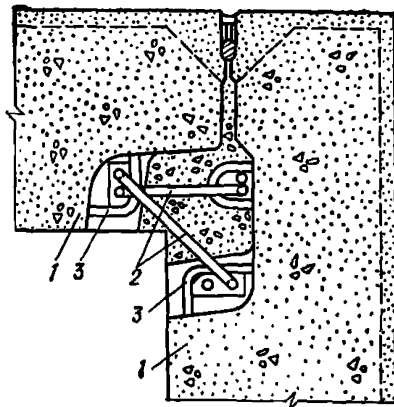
Сопряжение наружных стеновых панелей в углу здания под перекрытием (в уровне поэтажного пояса)
